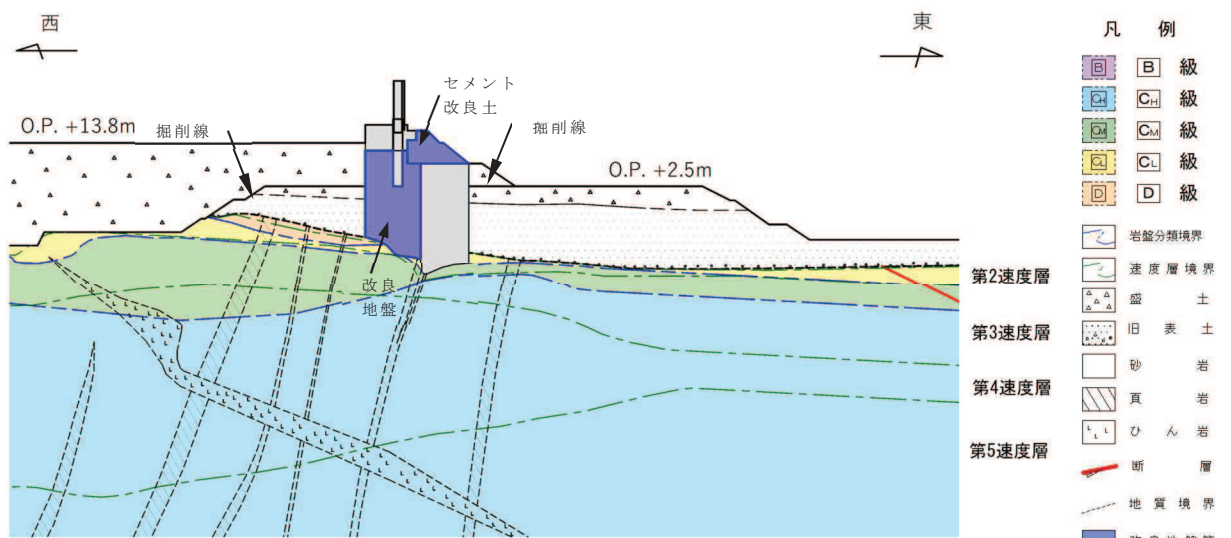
取水口の地質断面図 (㉕-㉕断面)
